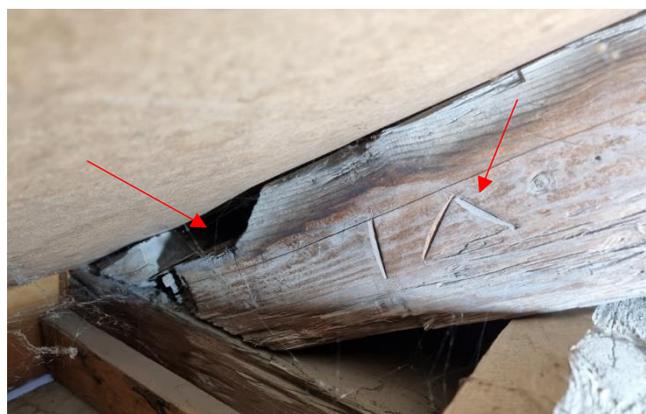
Anschluss auf Balkenlage Foto RB
